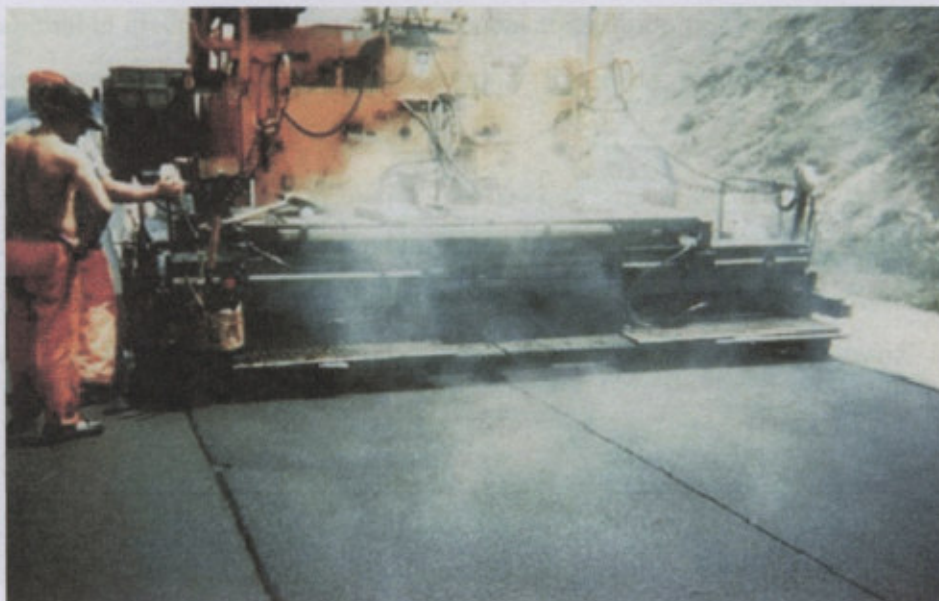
Extensión de una capa de slurry sobre un pavimento en servicio
